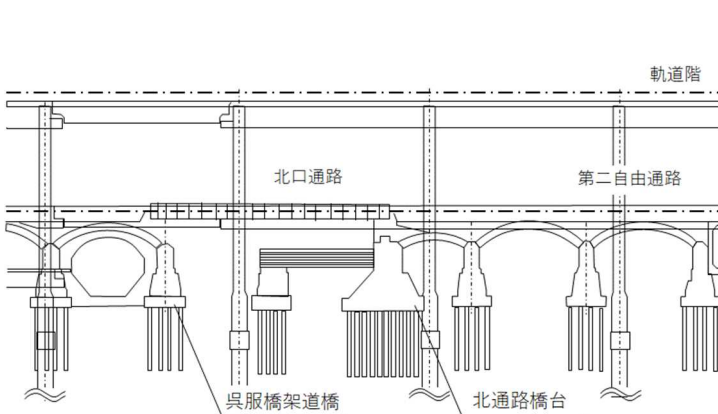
東京駅レンガ高架橋断面図 (A-A断面)
